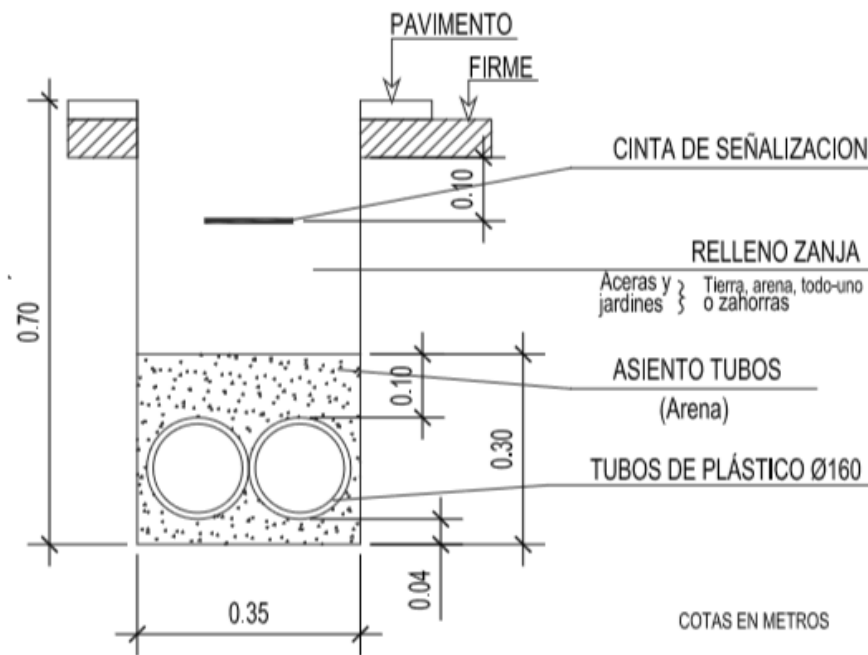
Detalle de canalización en B.T. y M.T. Fuente: Elaboración propia.
